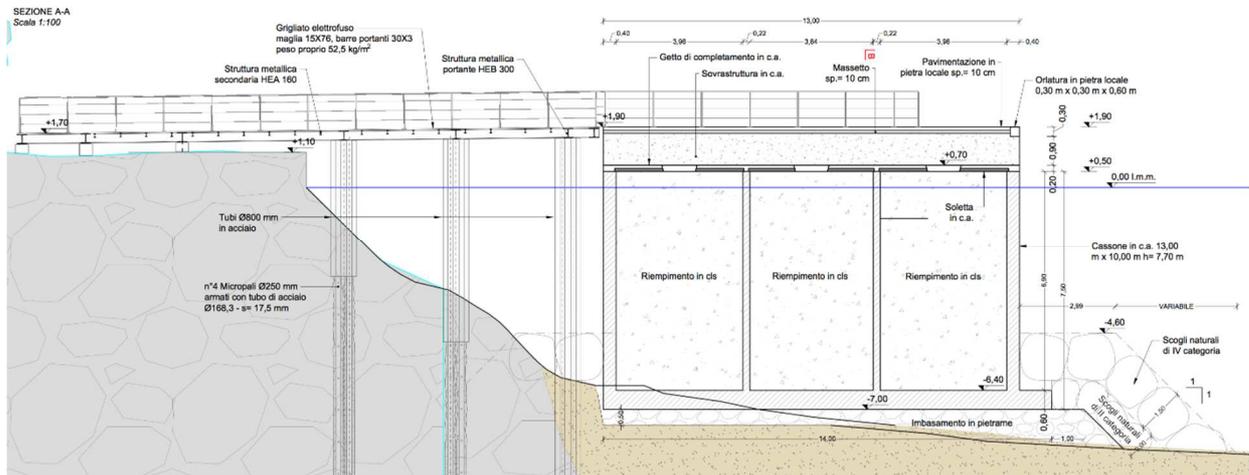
Sezione longitudinale estratto da 2017E037INV-02-D-OM-TAV002
